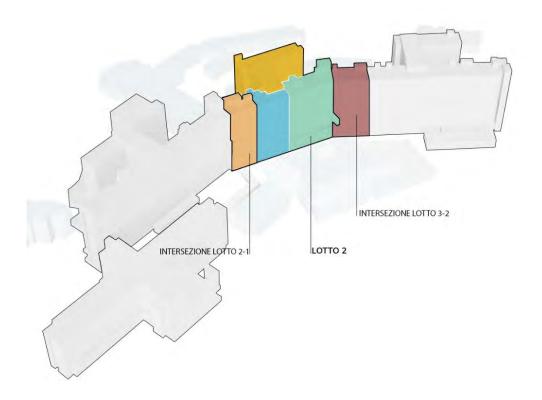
FASI DI RISTRUTTURAZIONE - LOTTO 2
